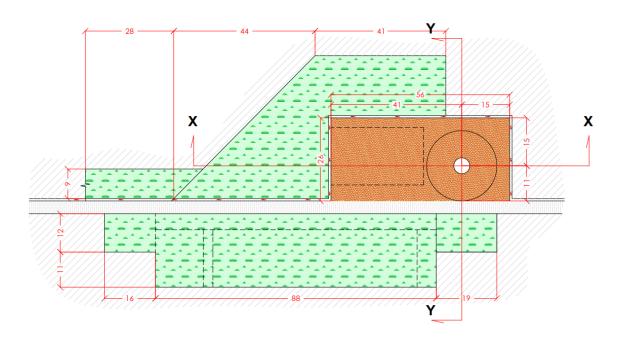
Planimetria tipologica ripristino aree piazzole
